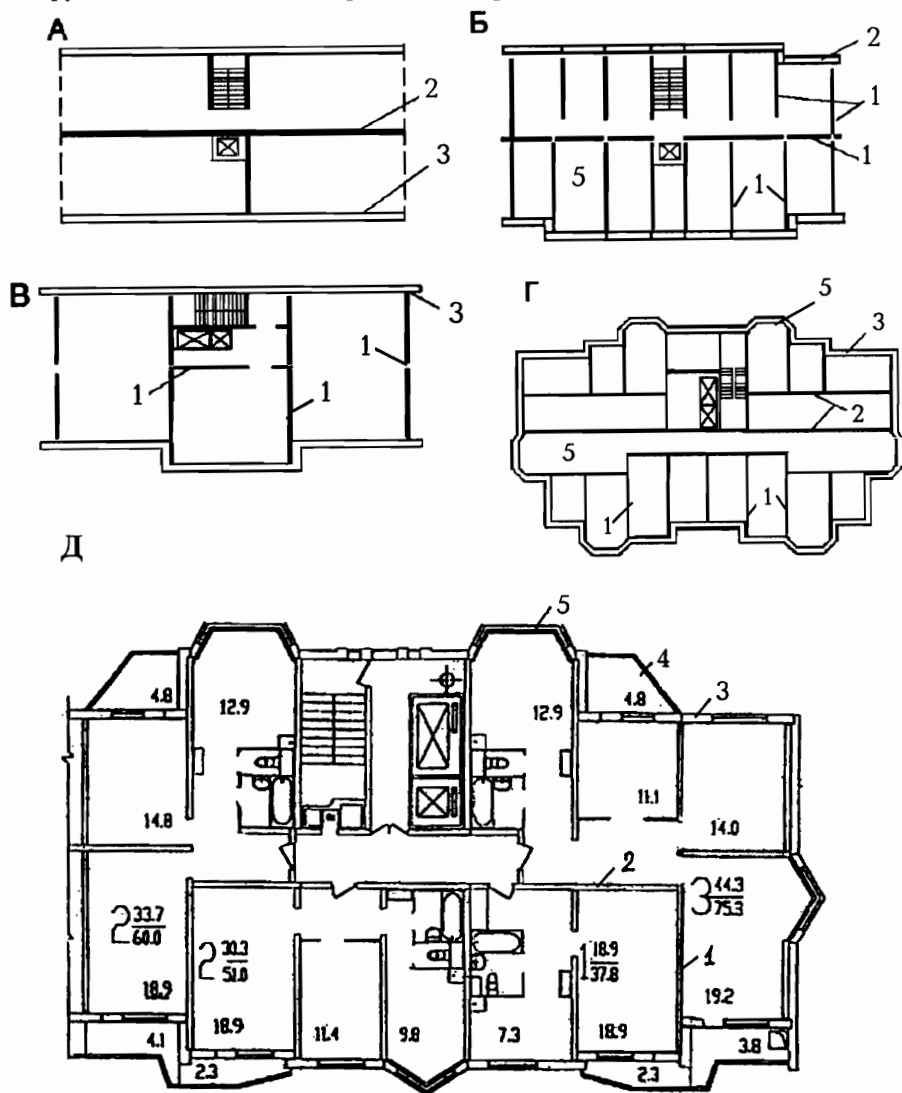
Основные конструктивные схемы крупнопанельных зданий: А - с продольными несущими стенами; Б - с узким шагом поперечных несущих стен; В - с широким модулем поперечных несущих стен; Г - с продольными и поперечными несущими стенами; Д - торцевая секция крупнопанельного жилого дома серии П-44Т: 1 - несущие поперечные стены; 2 - продольная стена; 3 - панель наружной стены; 4 - панели лоджий; 5 - панели эркеров
